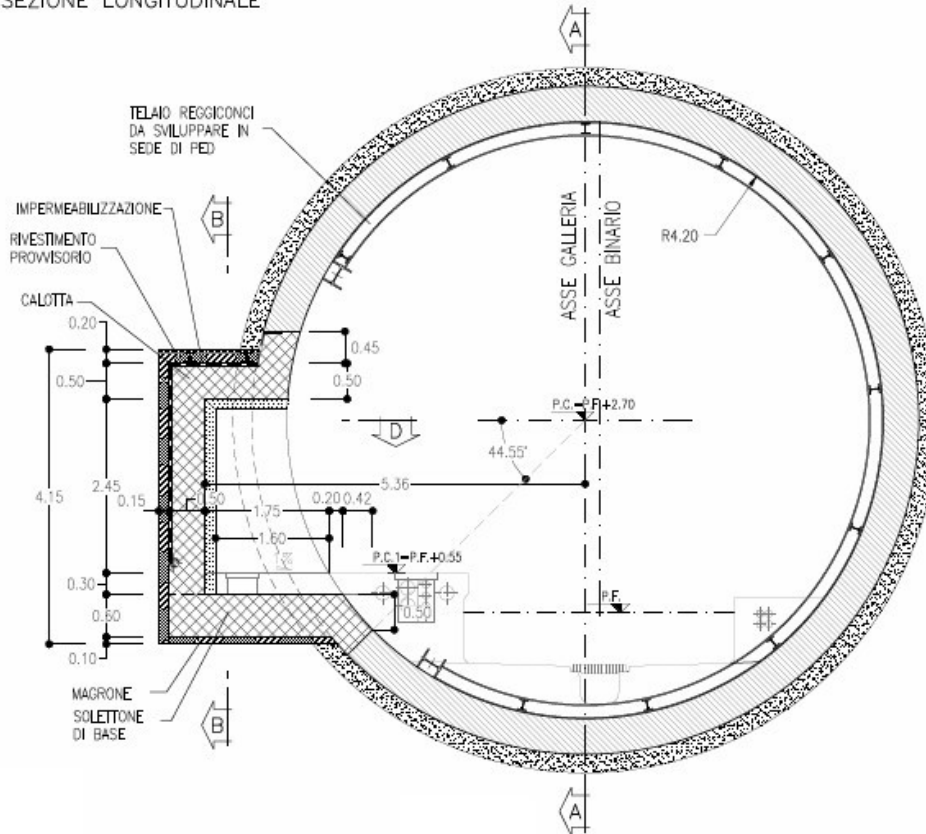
Profilo longitudinale nicchia tipologica e particolare fissaggio impermeabilizzazione
